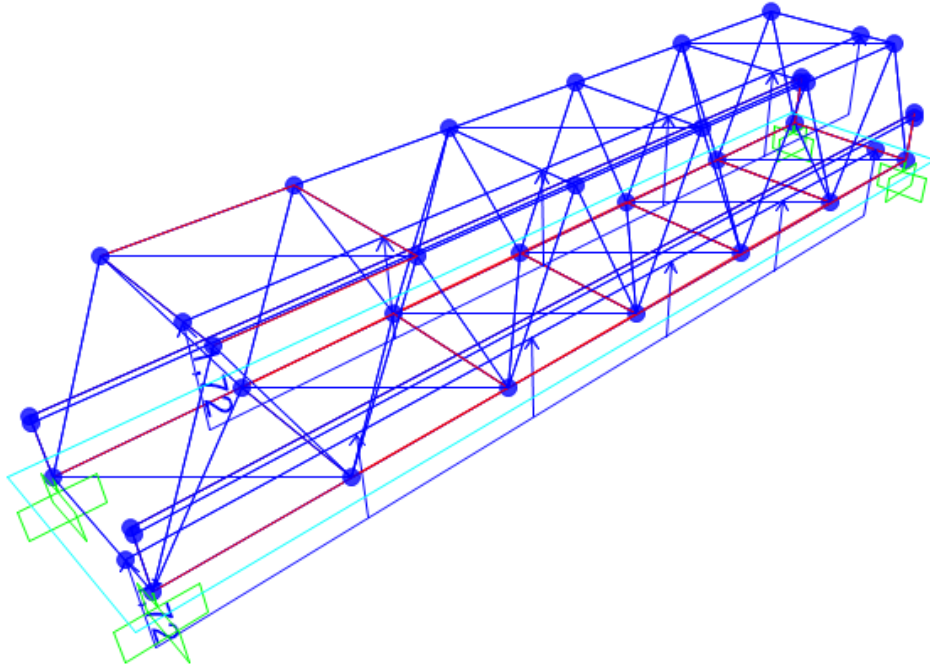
Aplicación de cargas de viento empuje vertical ascendente.
